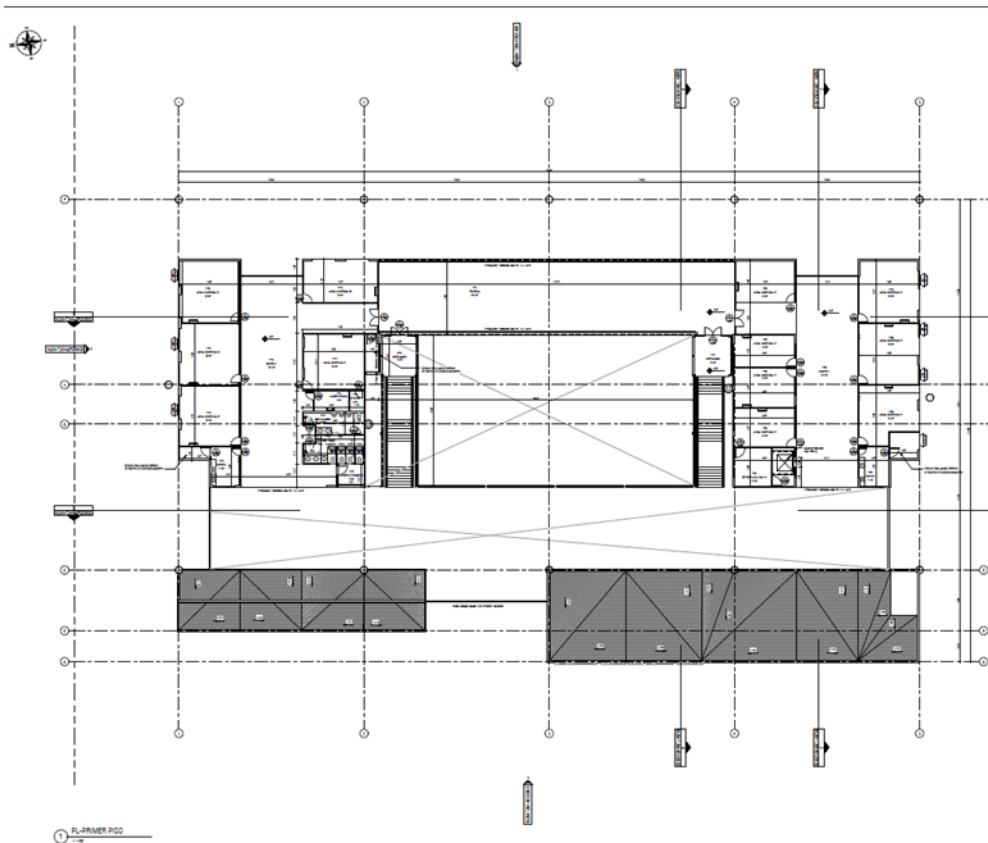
Planta alta nueva terminal de ómnibus Jesús María
